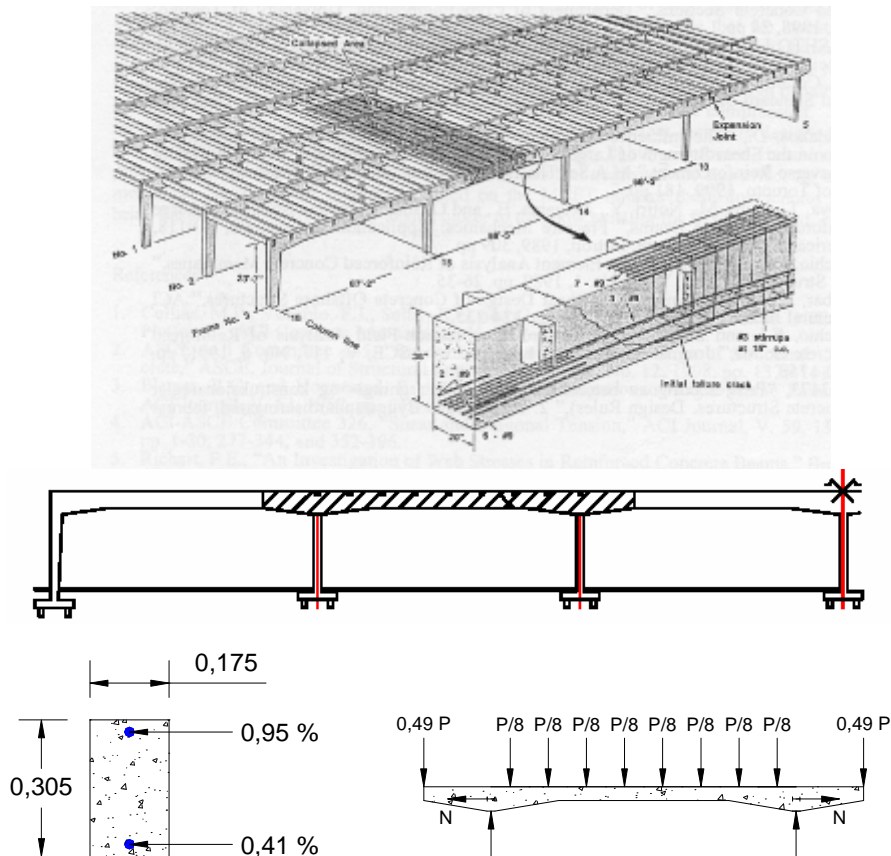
a. Detalle de las vigas en el Wilkins Air Force Depot Warehouse (Ohio, 1955)
